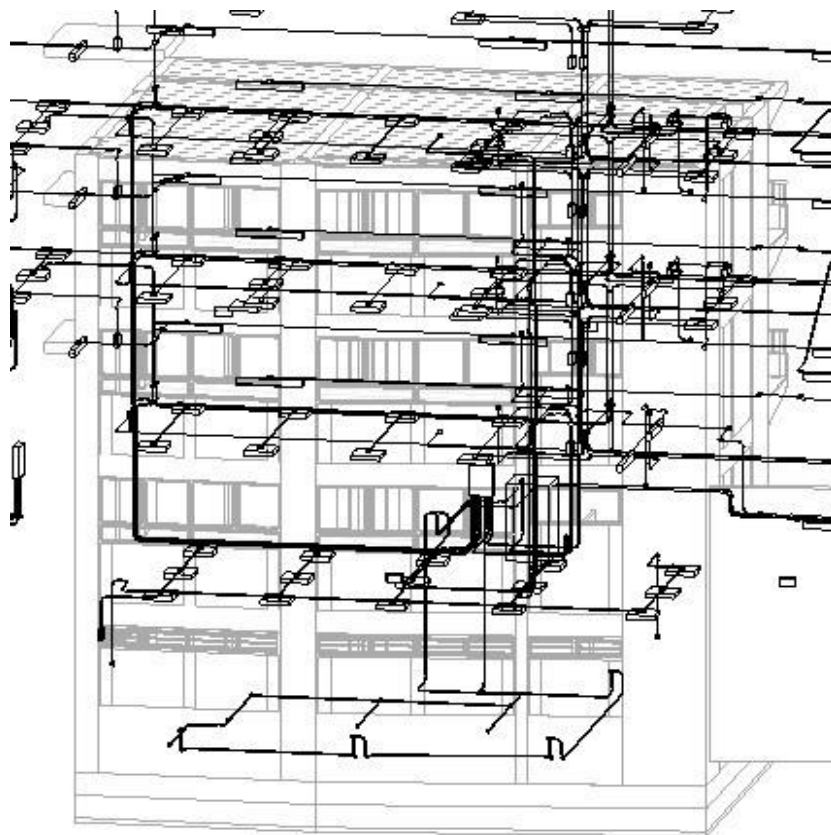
Modelado de Inst. Eléctrica del Pabellón N°01 – vista en 3D
